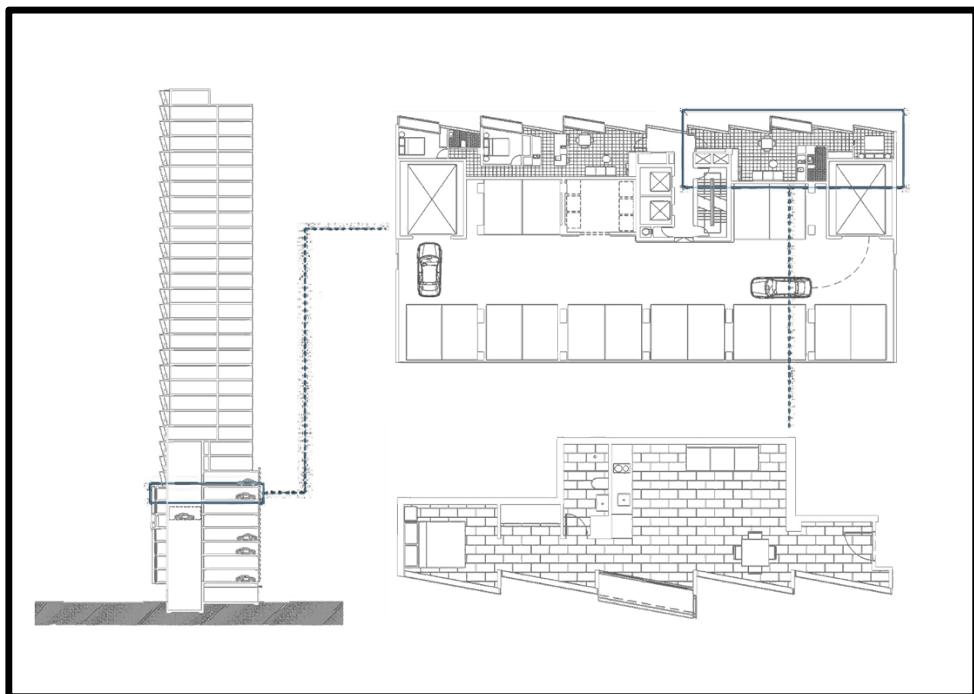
A' Beckett Tower Otopark Katı Planı (URL- 49)
